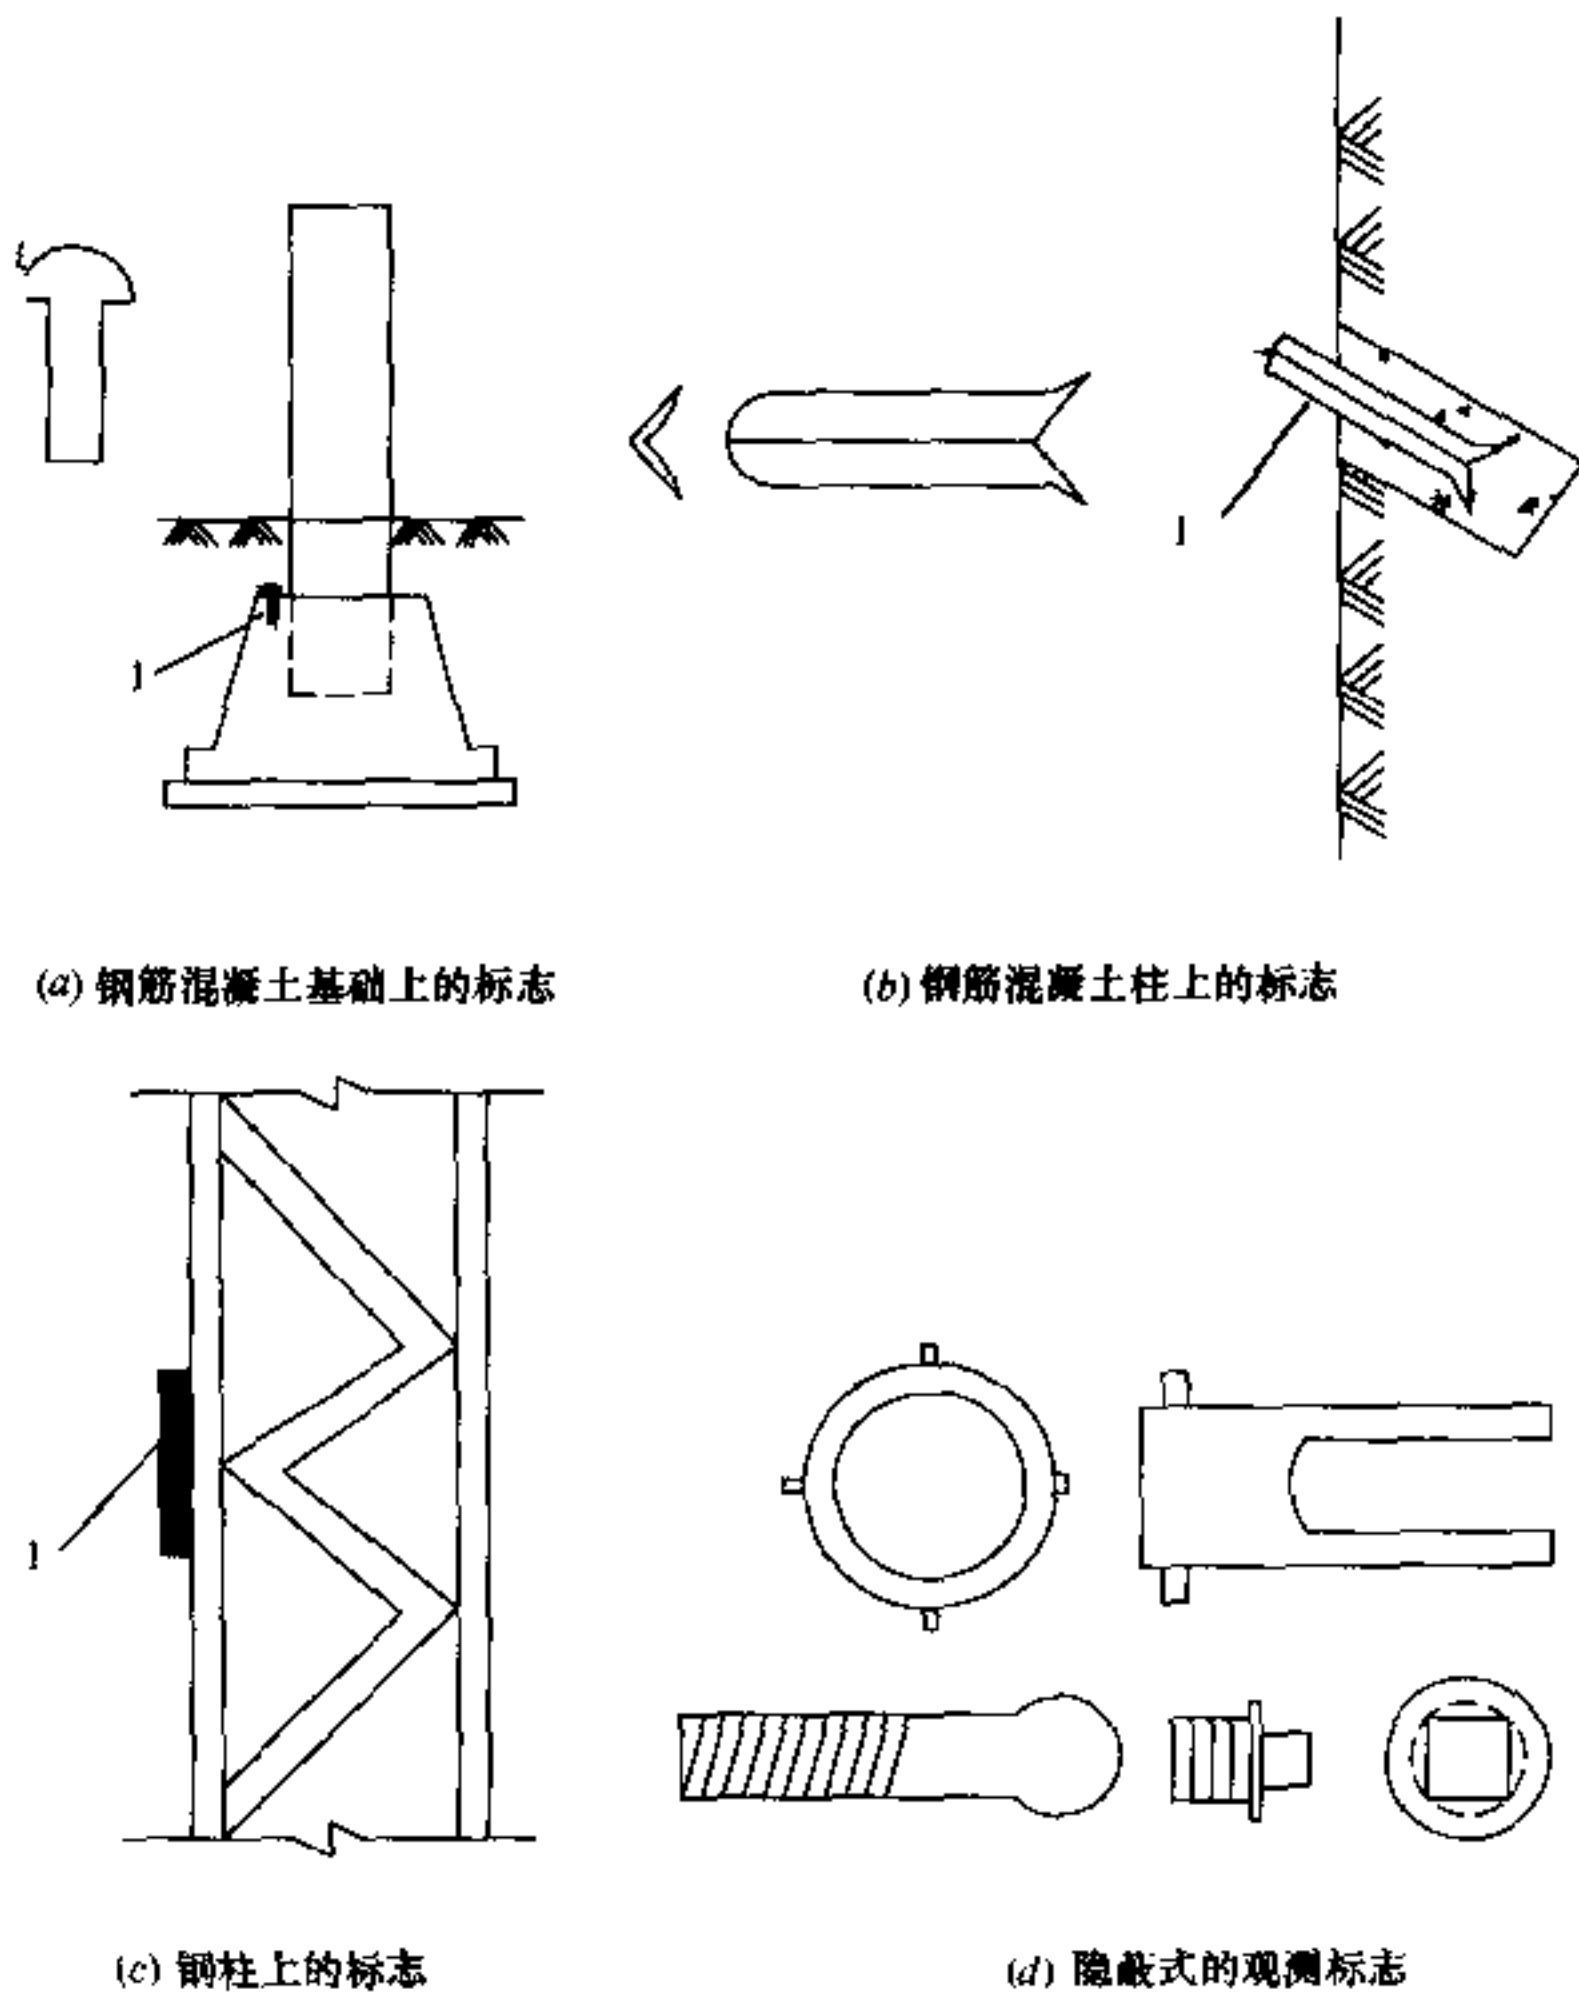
建筑变形观测点标志类型和埋设形式 (单位: mm)
